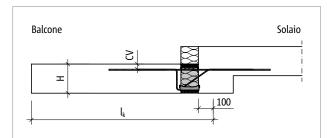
Schöck Isokorb® XT tipo KL-M1 – M8: schema statico
